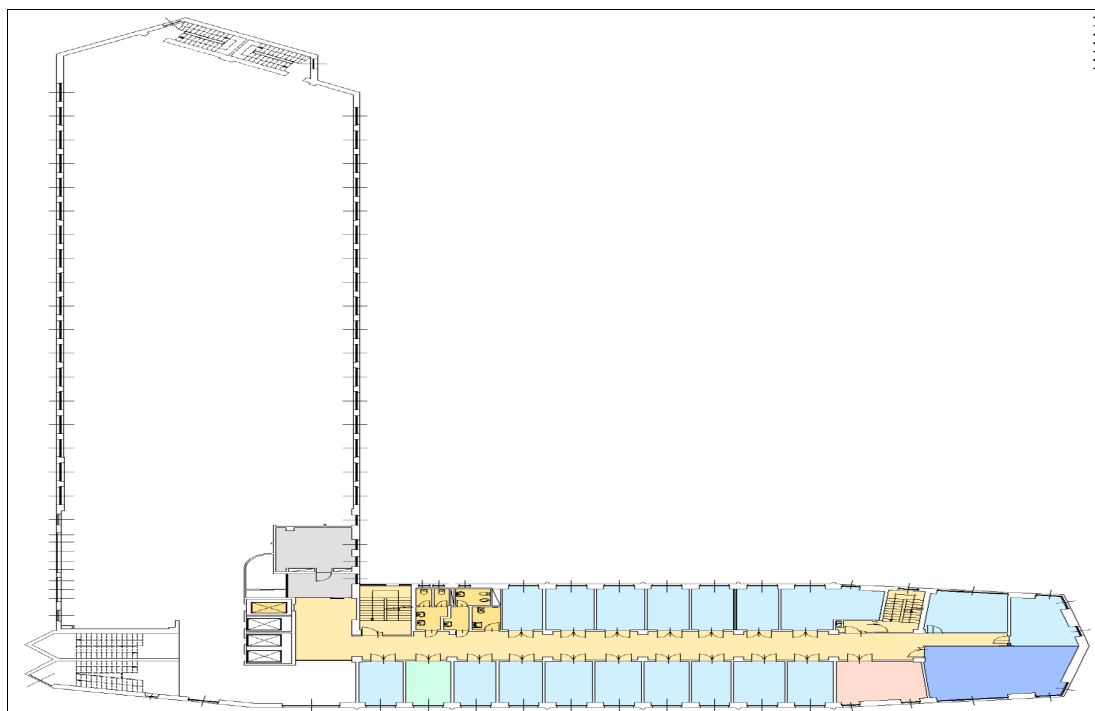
Planimetria del piano terzo dell'Edificio 14 (Politecnico di Milano, 2012)
